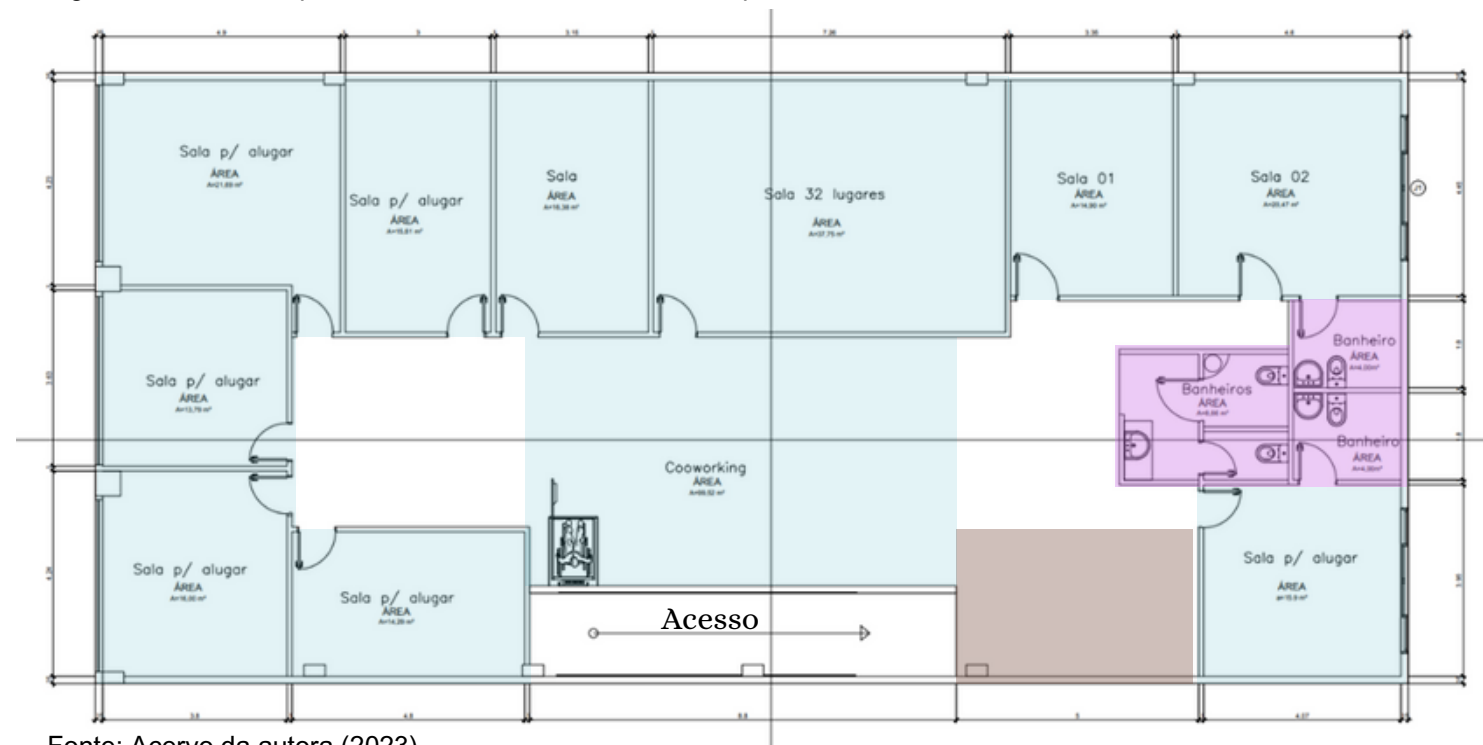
La vie empreendimento – Planta Baixa Térreo.
